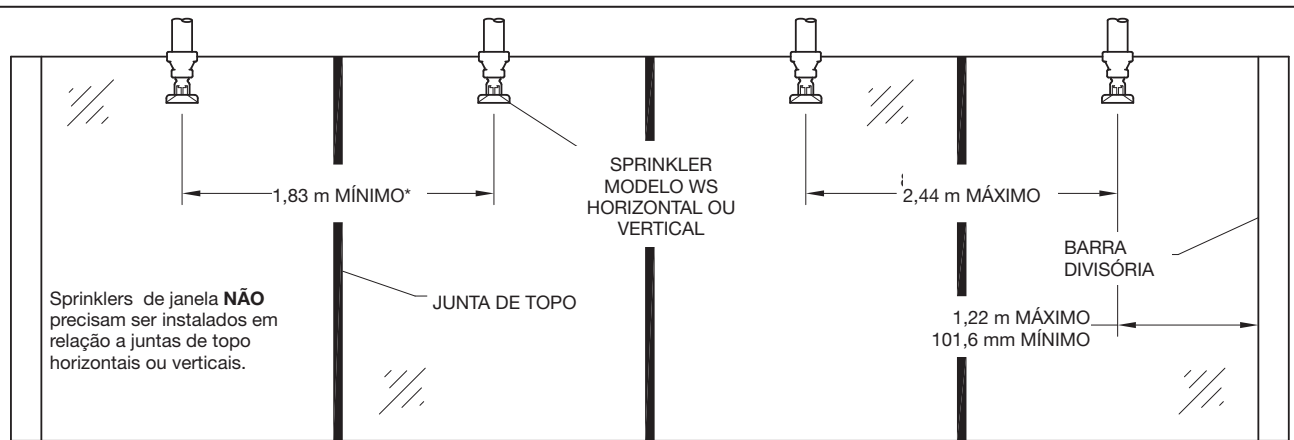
B-2 - MÚLTIPLAS JANELAS SEPARADAS POR JUNTAS DE TOPO
